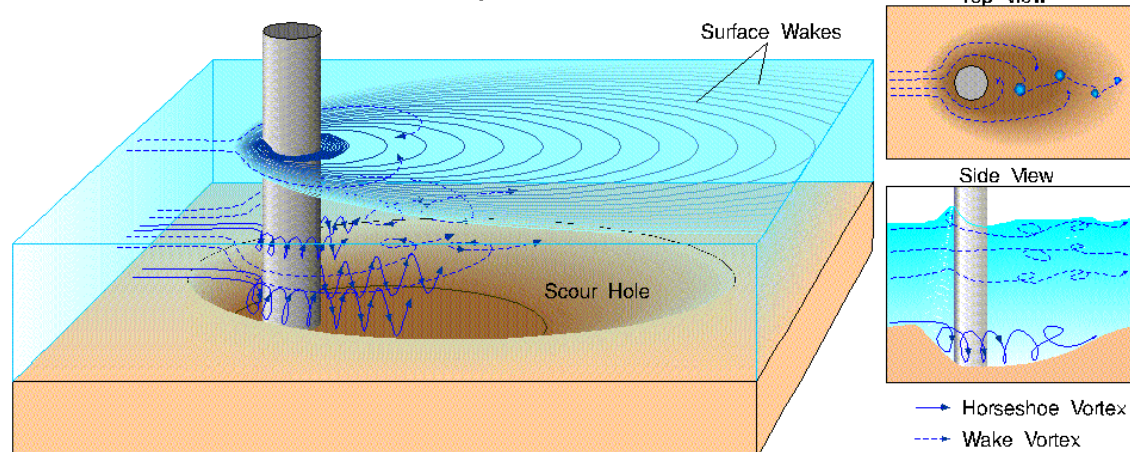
Phénomène d'affouillement au pied d'une pile de pont
